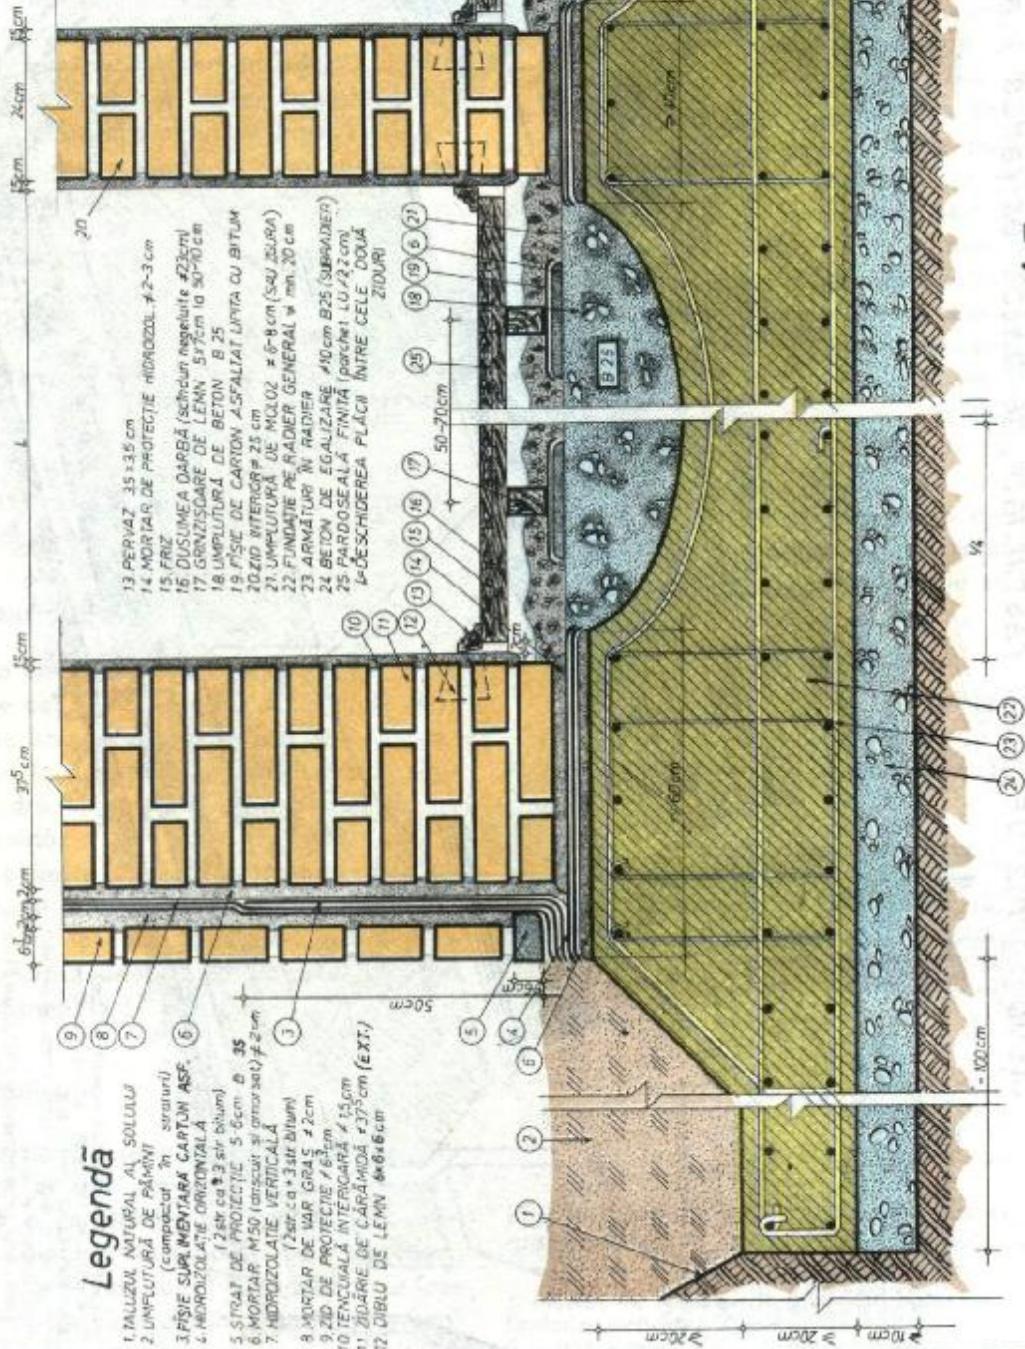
Fundație pe radier general, sub formă de bolti răsturnate de beton armat, cu extradosul plan, sub ziduri de cărămidă. Secțiune transversală :
